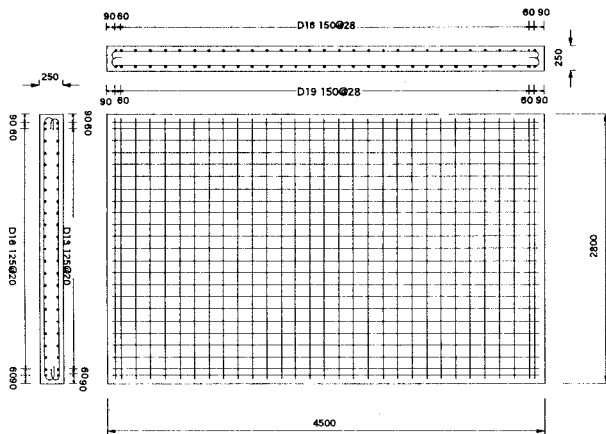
RC 80 供試体の形状・寸法 (単位: mm)
